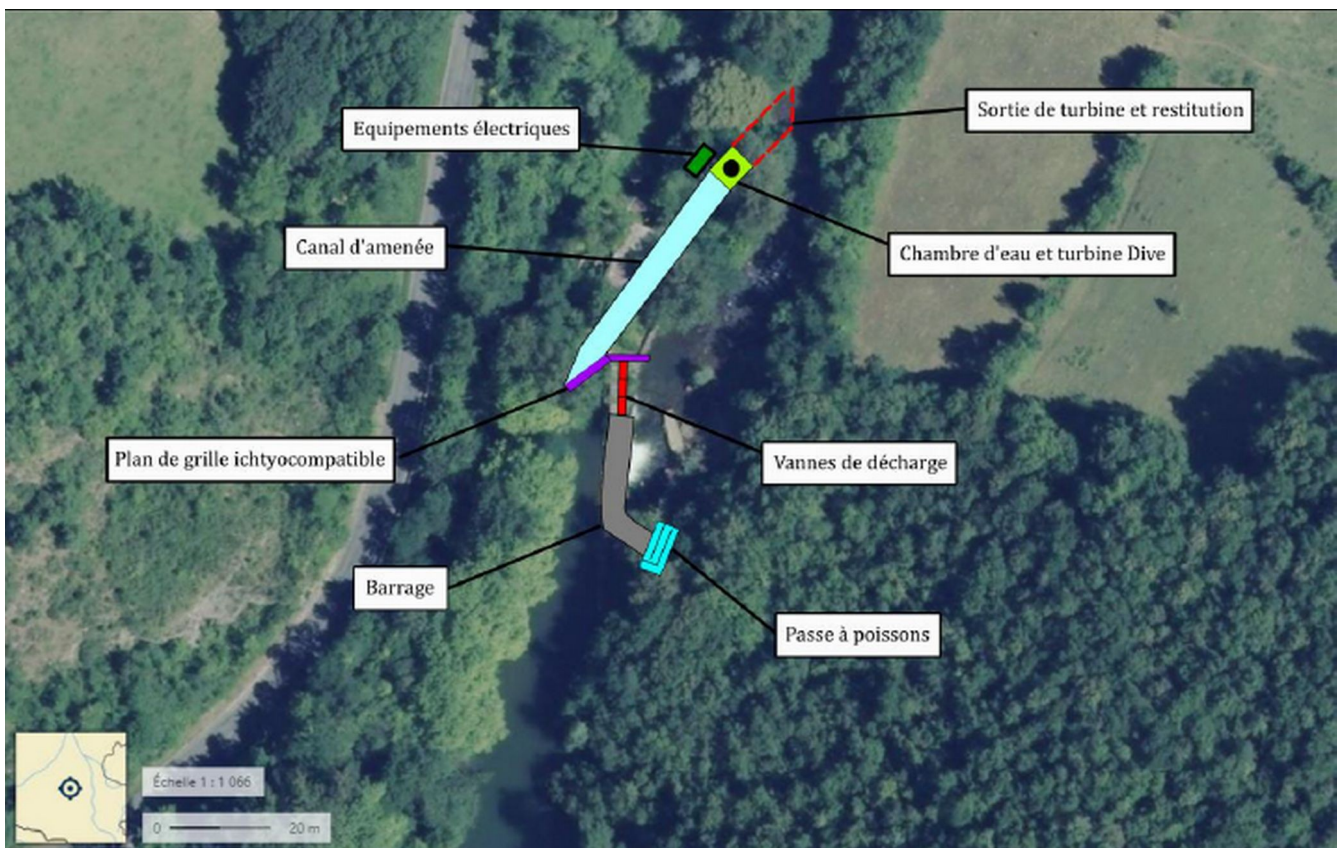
Plan des ouvrages après travaux (extrait étude d'impact)
